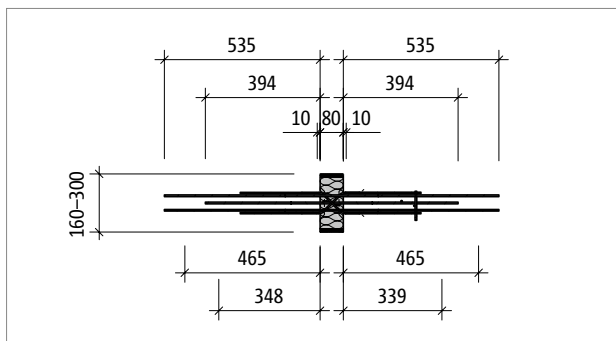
Schöck Isokorb® T type W-M1: Product layout
